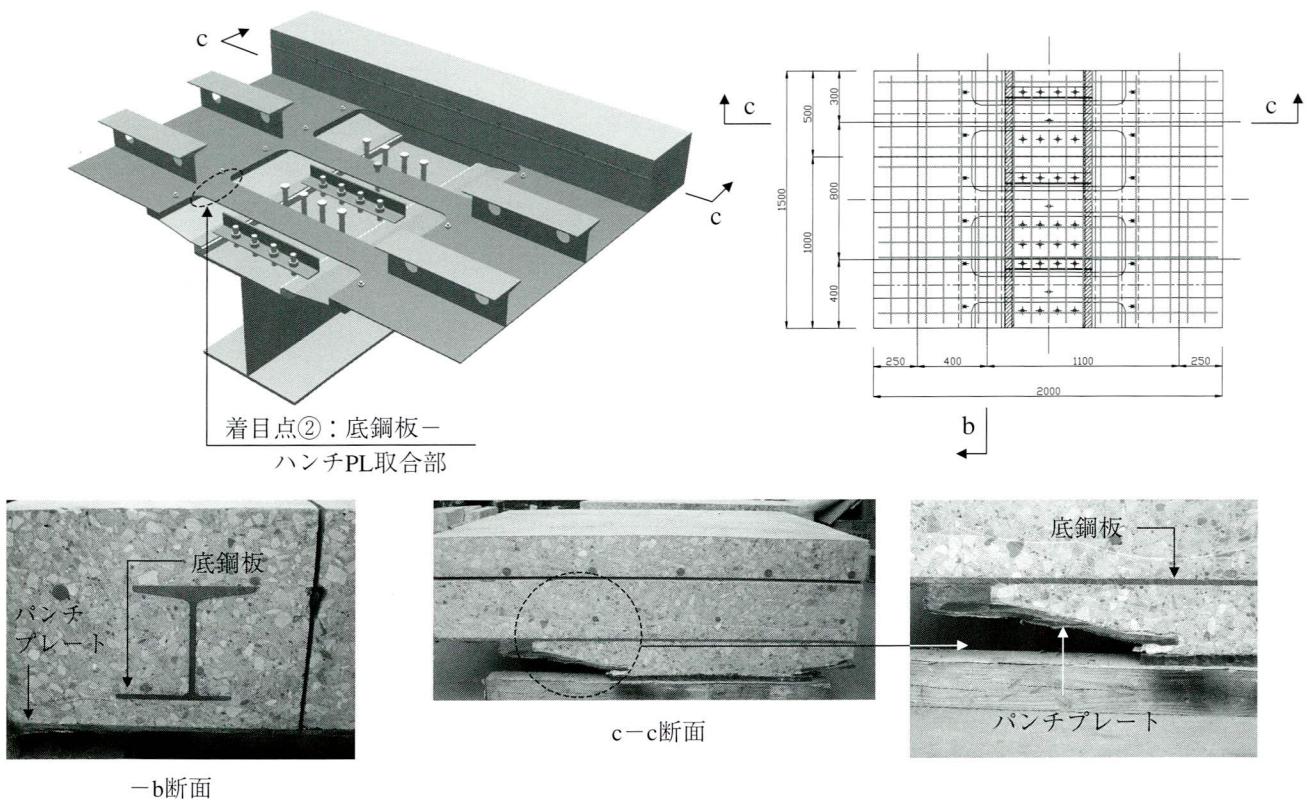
底鋼板—ハンチプレート取合部のコンクリート充填状況
